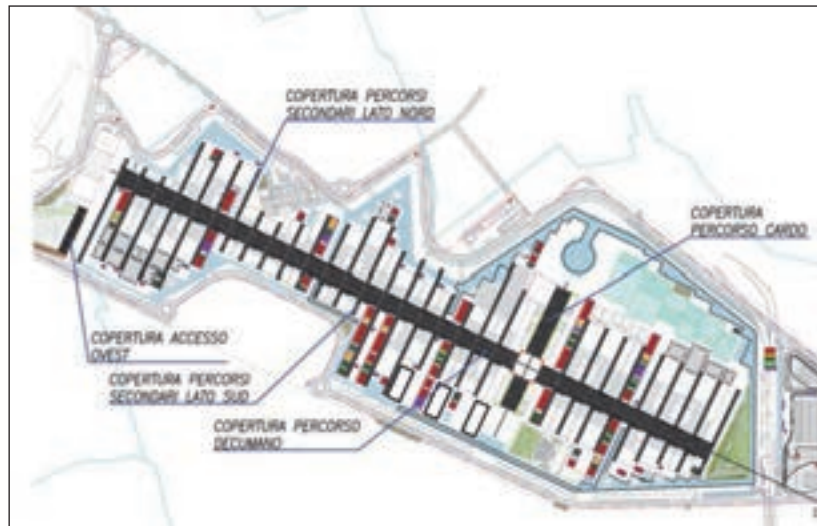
Disposizione in pianta delle strutture di copertura ai camminamenti
